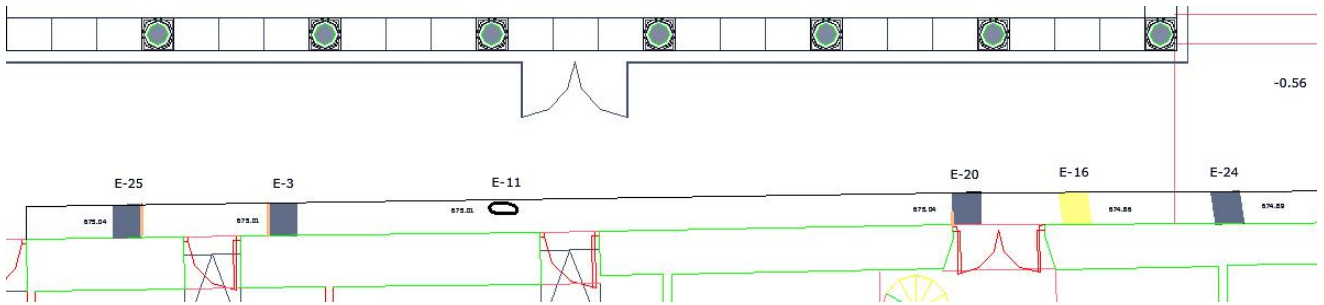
El muro Este del claustro no va paralelo al patio.
